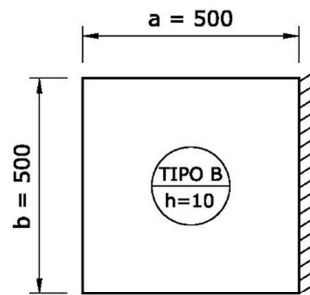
Modelo estrutural da Laje 2 (Tipo B)
